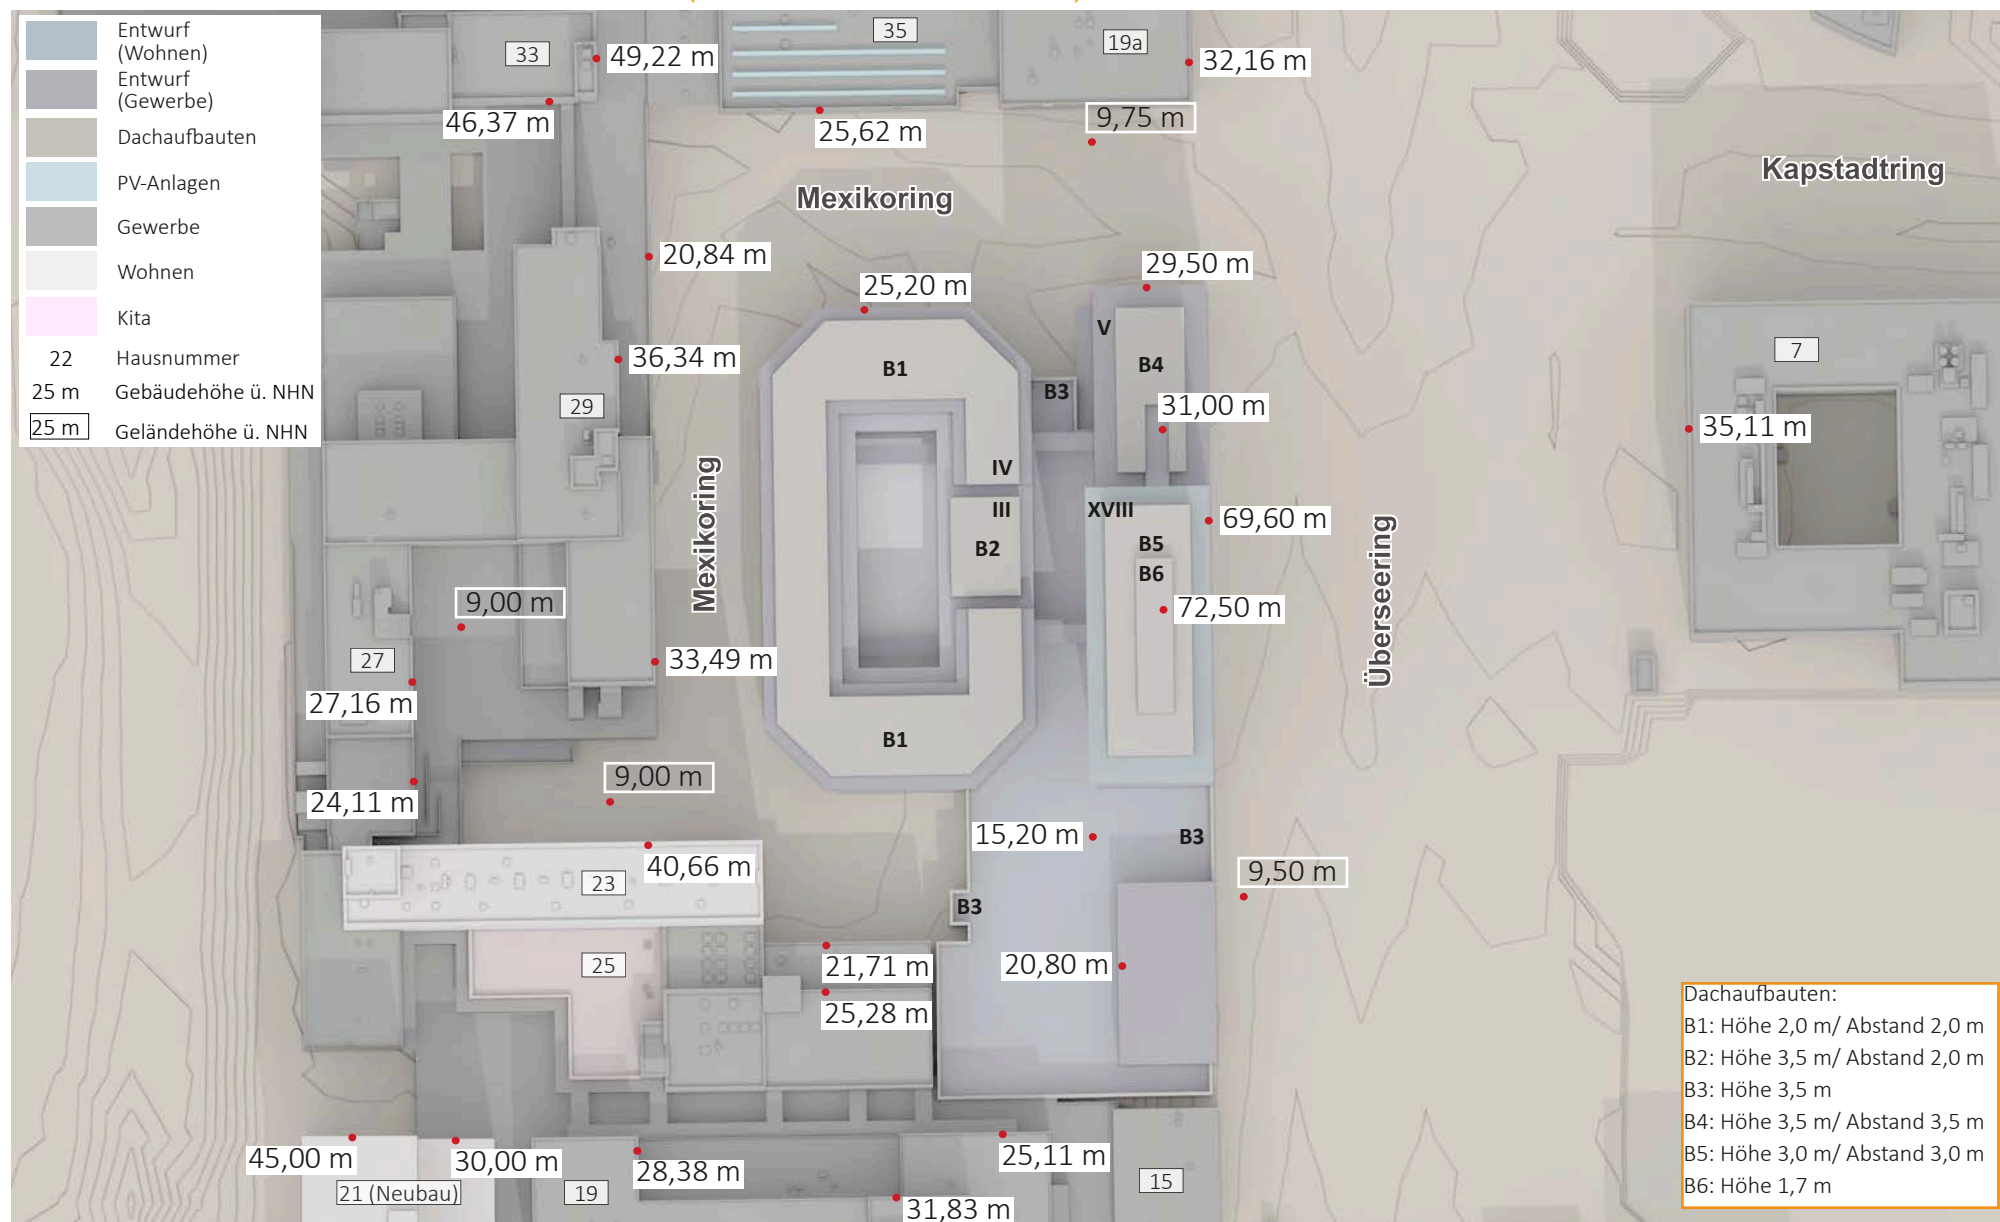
Modellhöhenplan der maximal möglichen Bebauung nach dem Bebauungsplanentwurf Billstedt 117, ergänzt um Balkone und Flächen für Technikaufbauten - Gebäudehöhen inkl. Attika bzw. Brüstung Eigene Darstellung.
